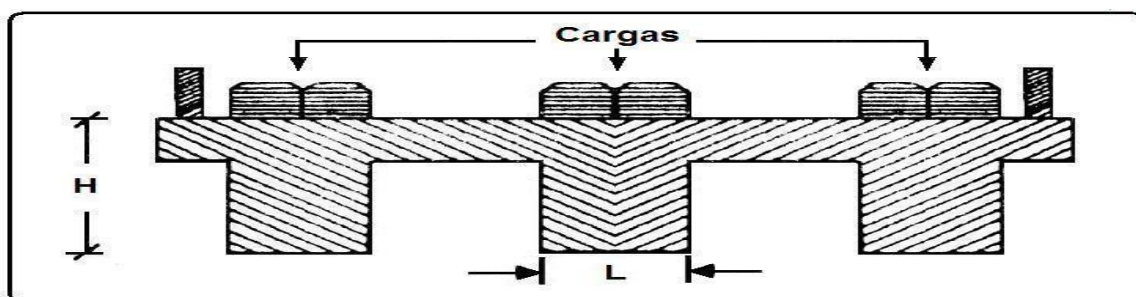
Perfil transversal da ponte de laje e vigas em "T".
